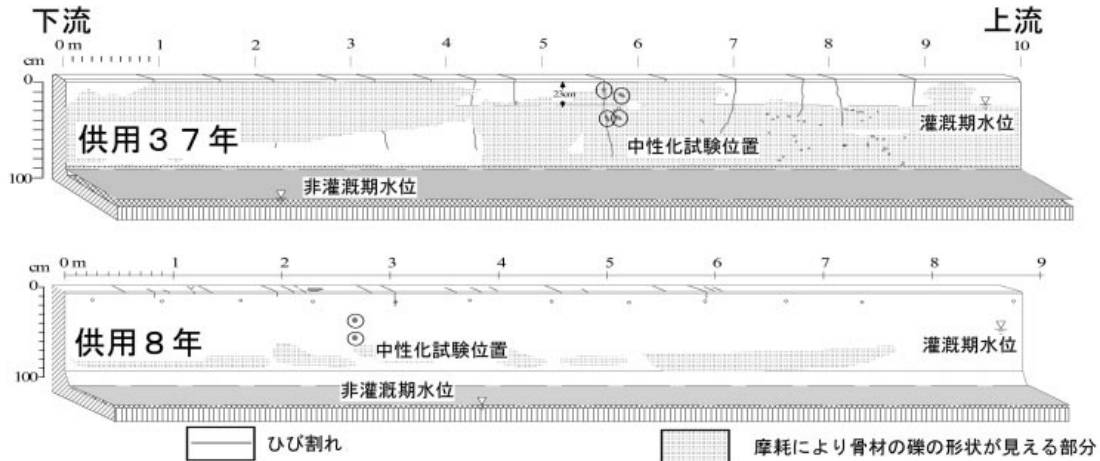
N地区の鉄筋コンクリート水路のひび割れの分布状況
